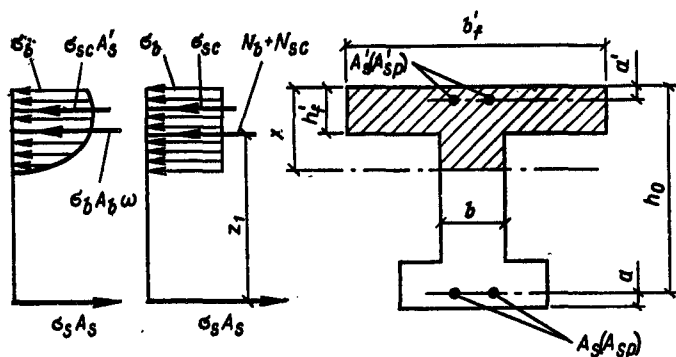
К определению напряжений в бетоне и арматуре элемента таврового сечения с полкой в сжатой зоне
